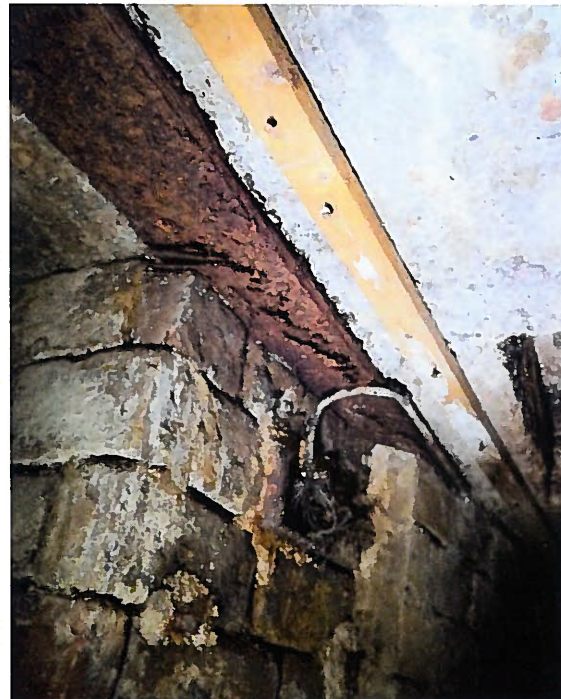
Raum U2.R.70 Deckenausschnitt, Ortbeton, Stahlträgern, Wand im Läuferverband dahinter Korkstein, Sept. 2017
